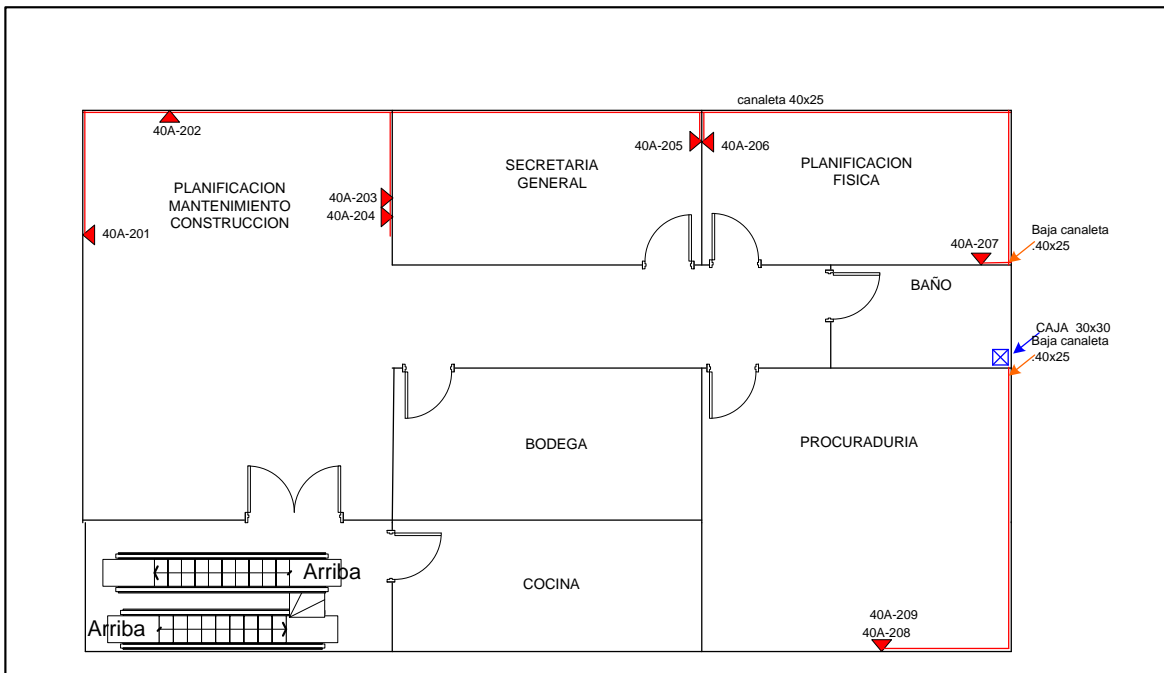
Plano de Comunicación Tercera Planta –Edificio Verde
